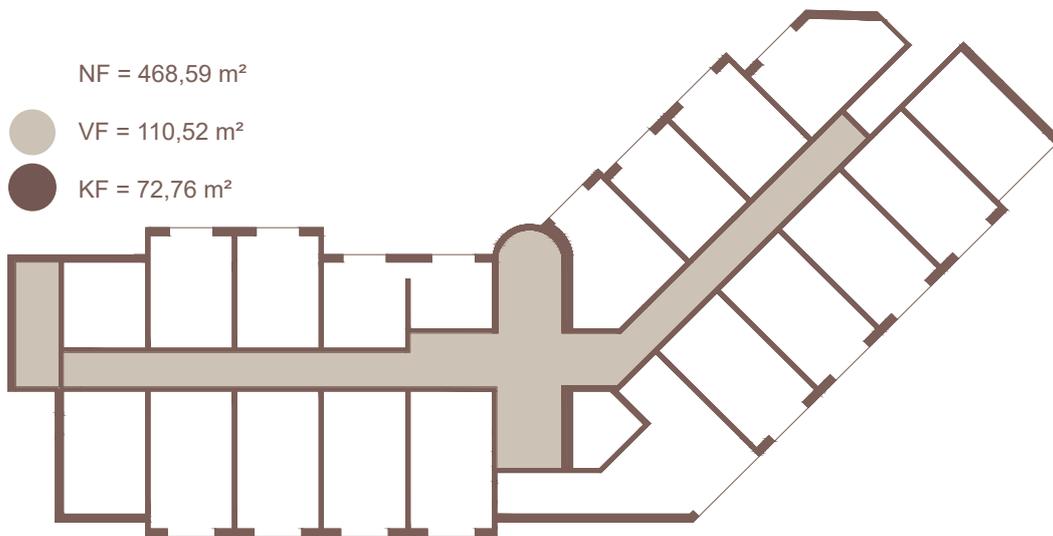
Flächenberechnung Zubau - Erdeschoss
